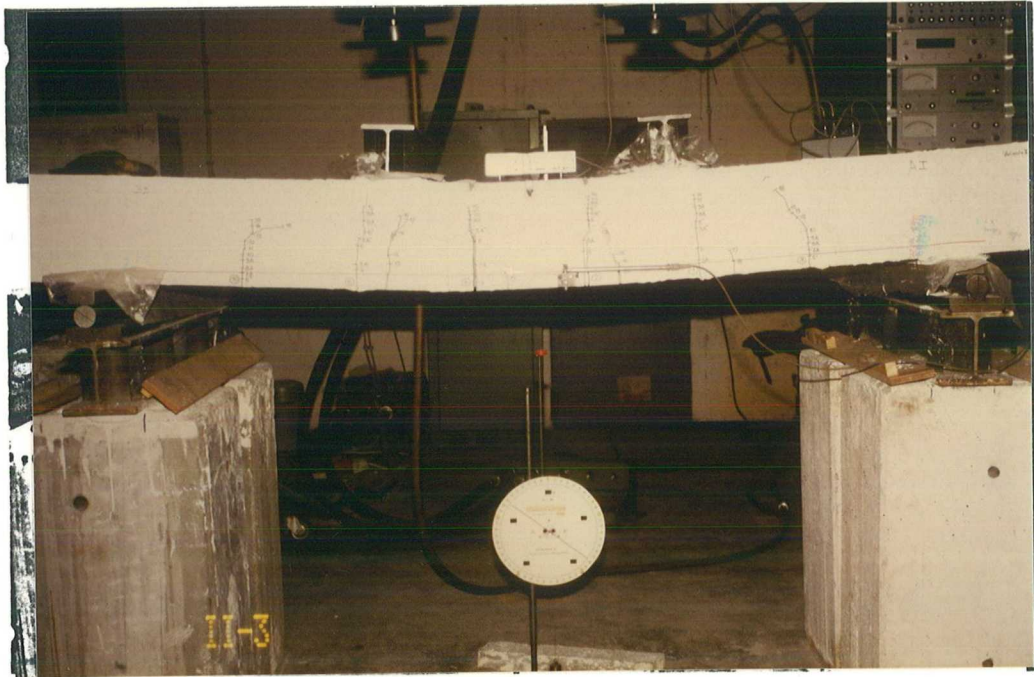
Versuch II/3 nach dem Versagen durch Biegebruch
